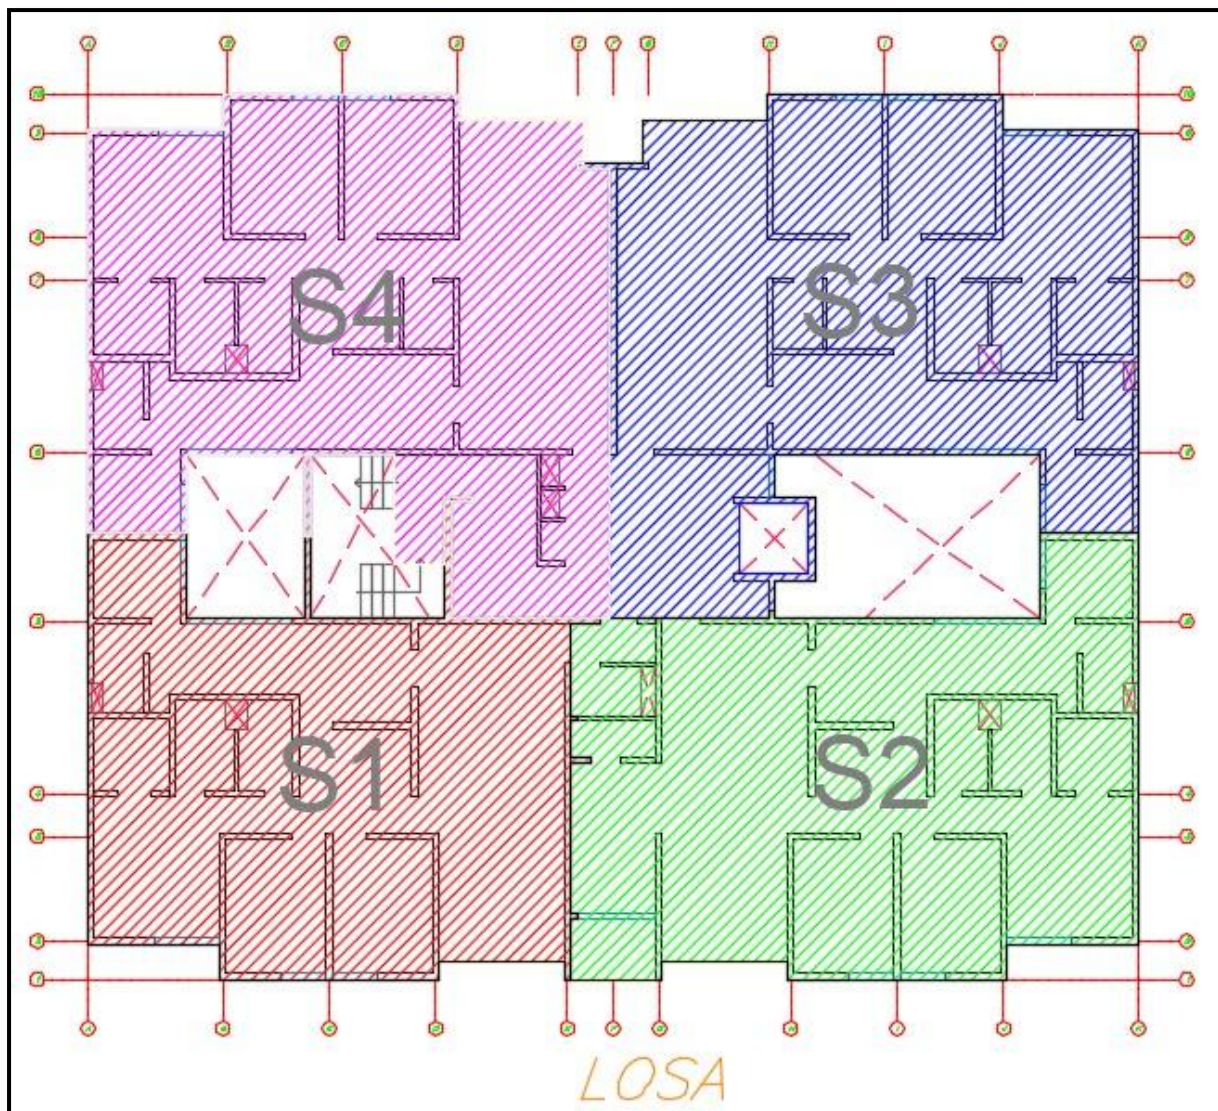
Sectorización de losa, Edificio 6 Villa Verde 2
